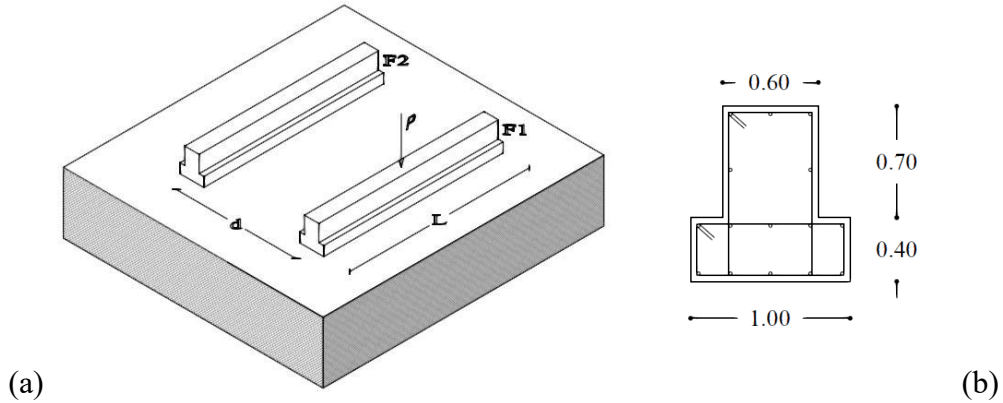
Travi parallele su suolo elastico. Vista tridimensionale (a); dimensioni (in metri) sezione trasversale delle travi (b).
